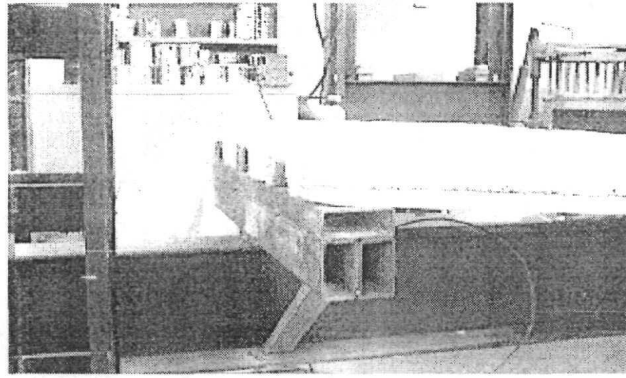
Deslizamiento de extremo, debido a la pérdida de adherencia.
